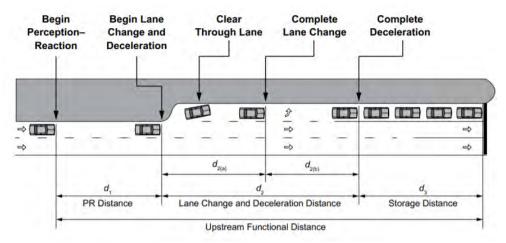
Carril de giro a la izquierda Fuente: (AASHTO, 2018)
